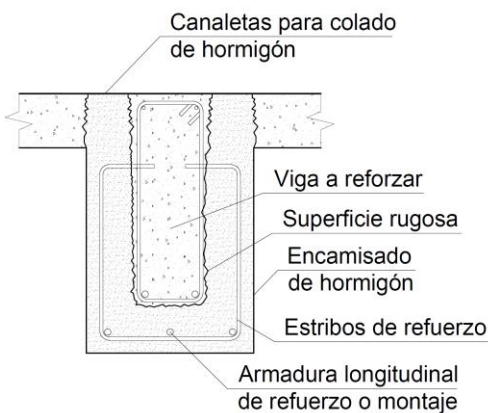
Refuerzo de viga mediante encamisado de hormigón armado
